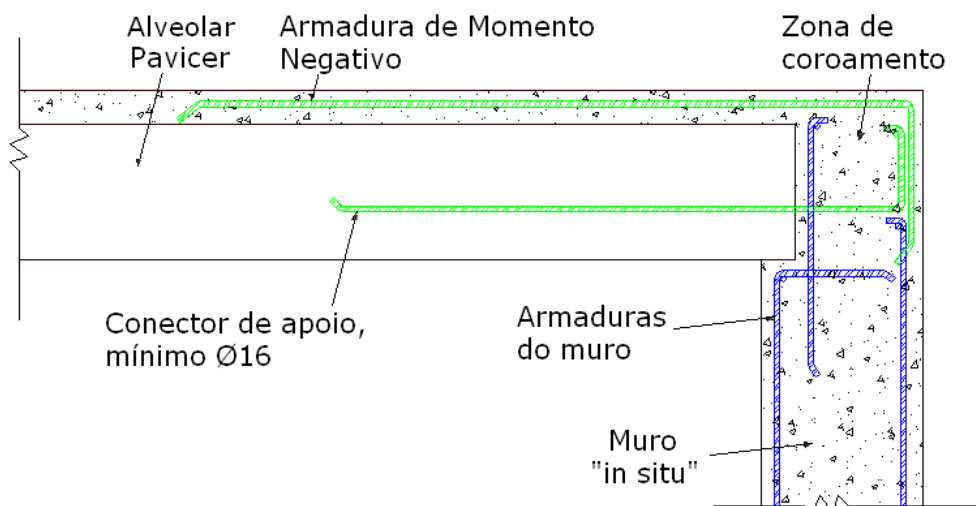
Pormenor tipo de apoio em muro de betão armado.
